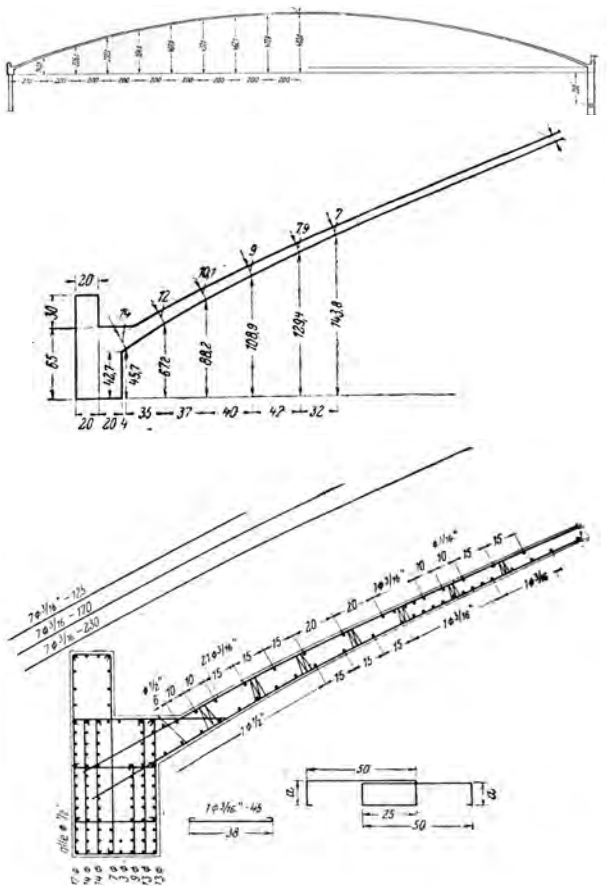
Emílio Baumgart: Cinema Roxy, Rio de Janeiro. No alto, corte. Ao centro, engaste da cúpula na cinta de contorno. Acima, detalhe da armadura. [CONCRETO nº75 jun de 1945]:198
